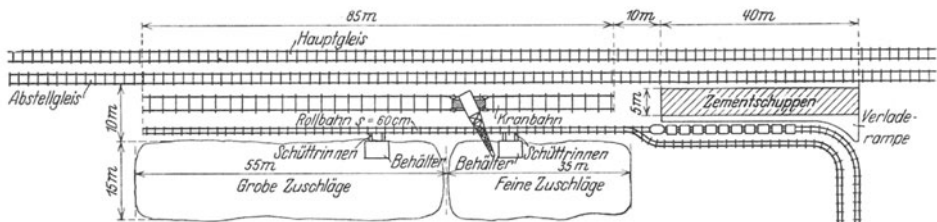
Baustofflager bei Rollbahnbetrieb.
